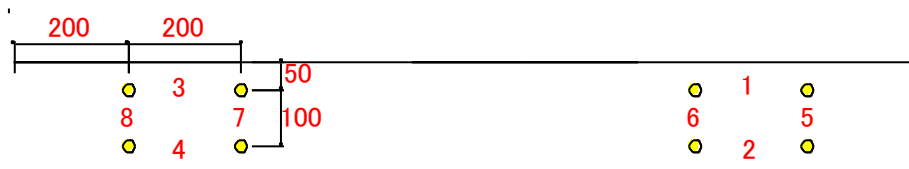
1600 mm供試体プラグ位置 (単位:mm)
